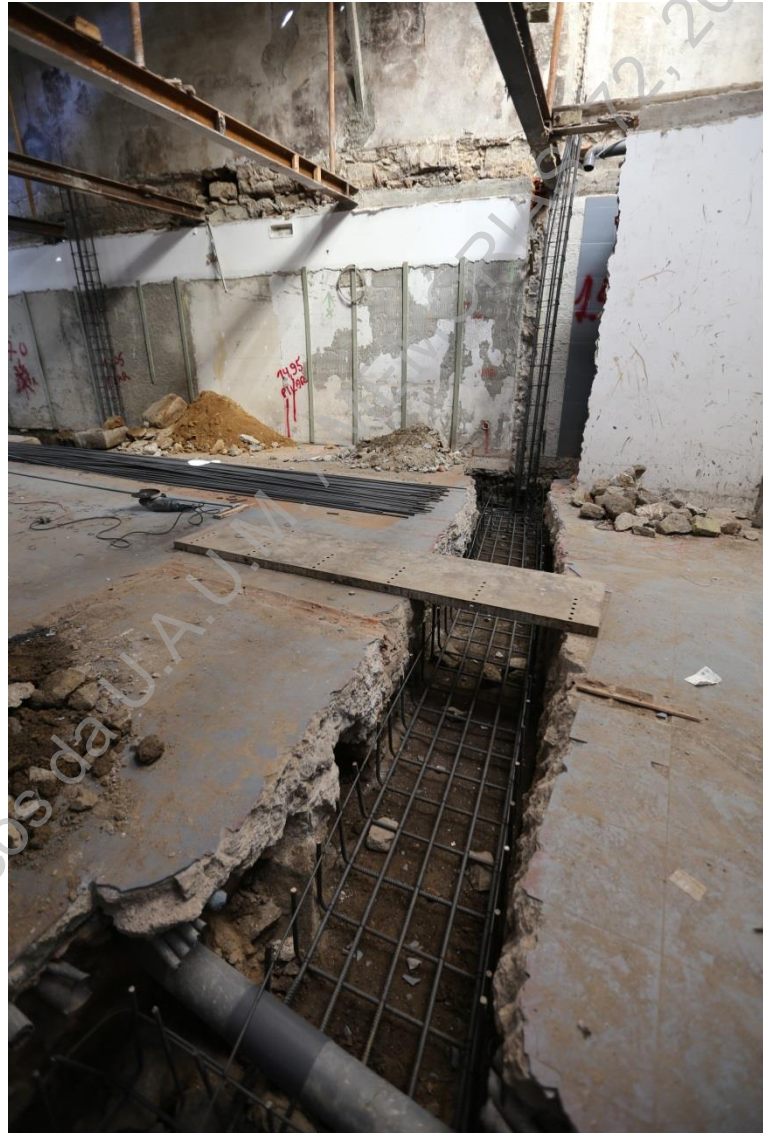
(IMG_2072) – Colocação de ferro pra betonagem da sapata 4 (S/N).
